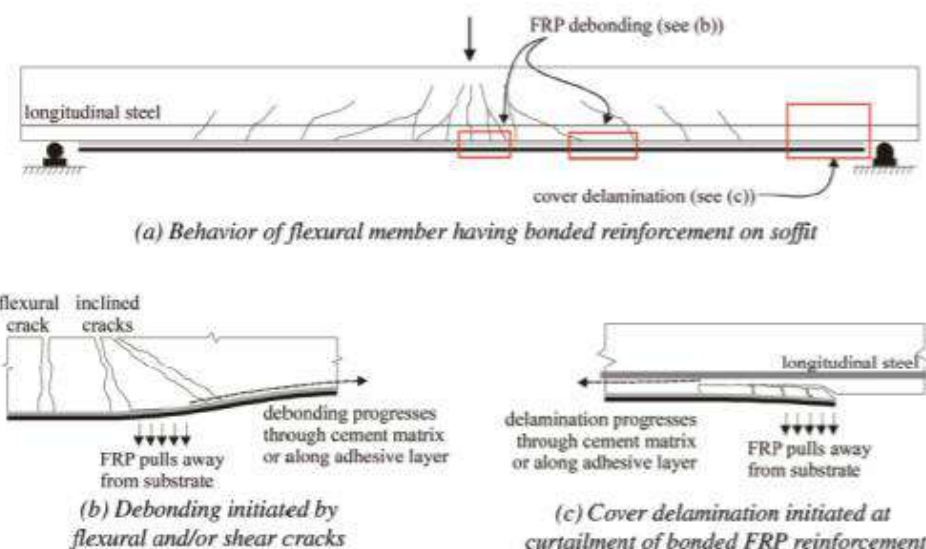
Sistemas fibra enlazadas para reforzar la estructura. [41]
